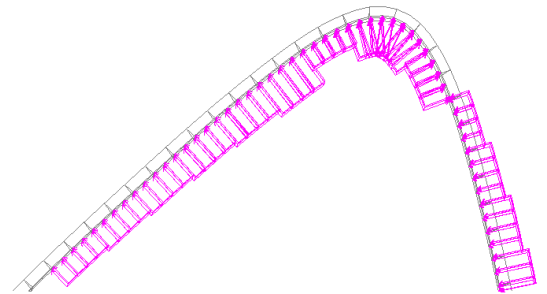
Загружение в ПК SCAD на фрагмент покрытия от ветровой нагрузки (Y-)
